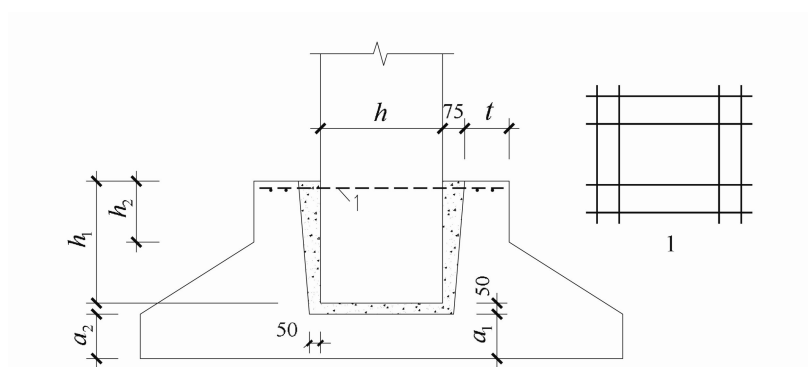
预制钢筋混凝土柱与杯口基础的连接示意
